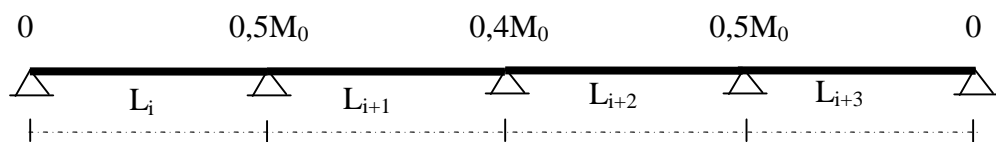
Schémas statique d'une poutrelle plusieurs travées.
